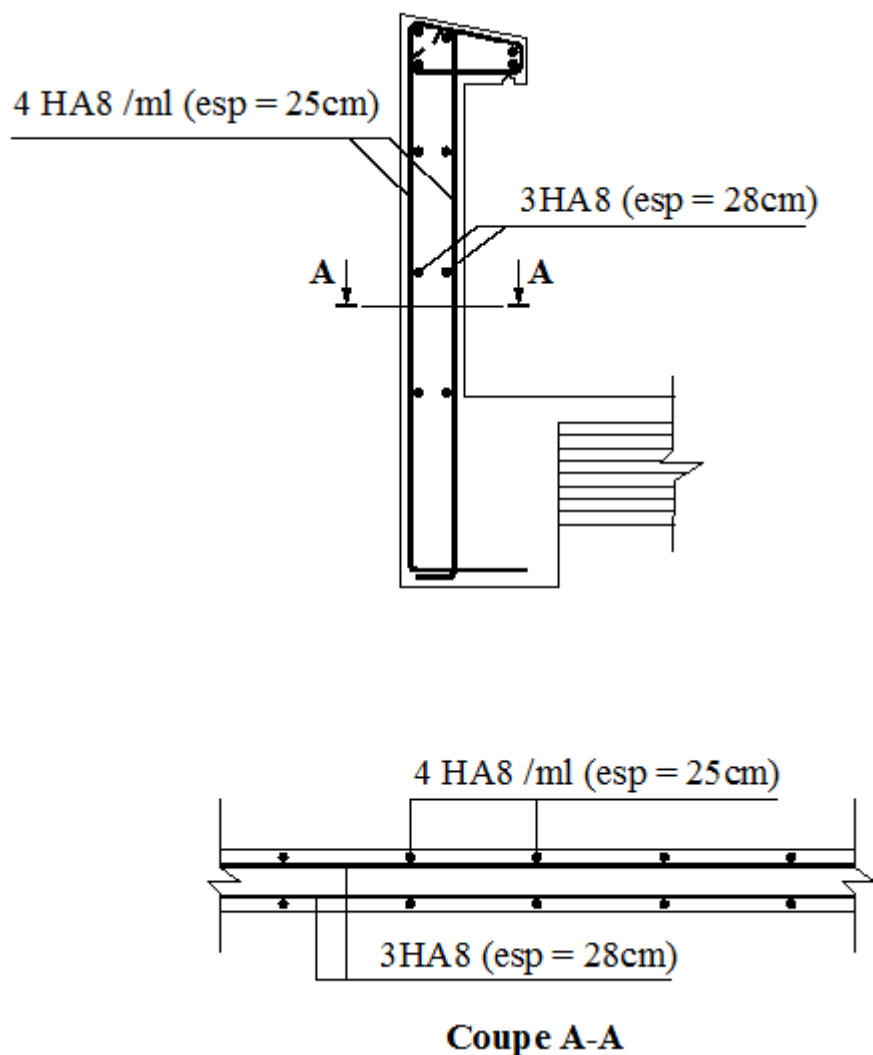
Plan de ferrailage de l'acrotère.
